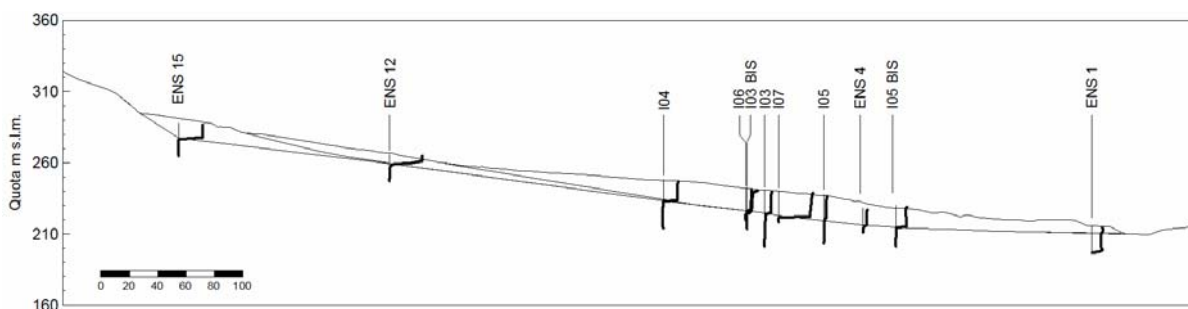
Pianoro: sezione longitudinale del pendio e ricostruzione del meccanismo di collasso (Olmedo, 2007)
